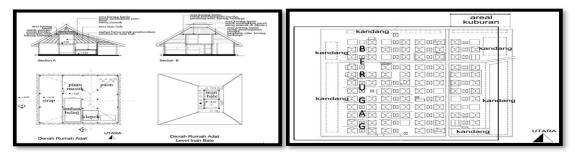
Plan and shape of the Segenter Traditional Villages (Made Wirata & Ngakan Putu Sueca, 2014)
